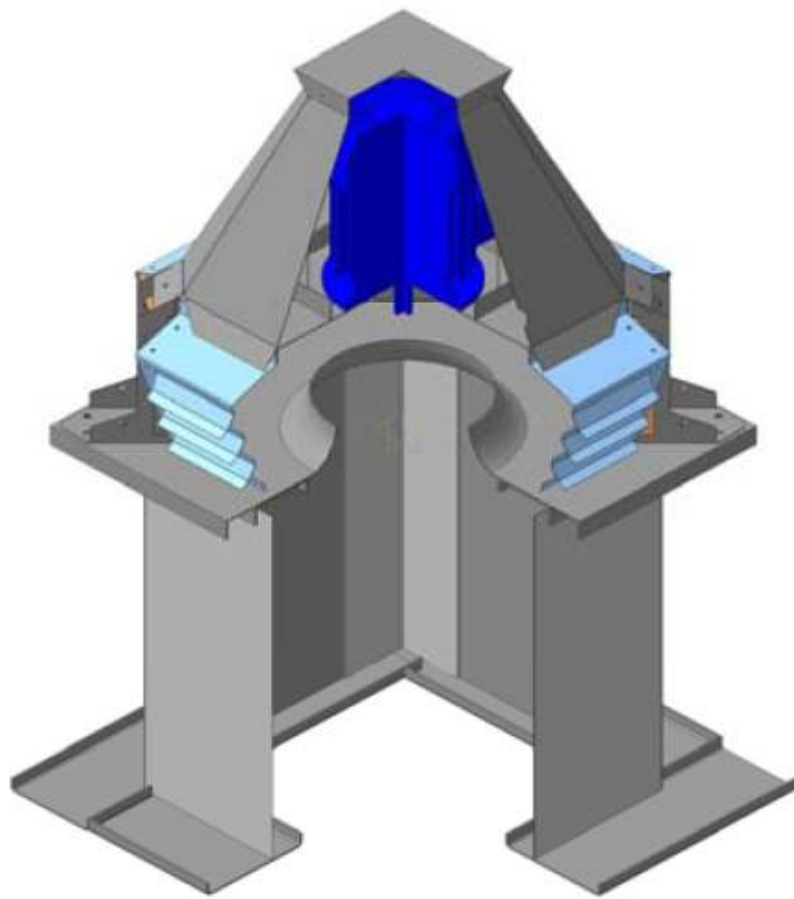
Монтаж крышного вентилятора КРОС-ДУ на стекле СТАМ производства ООО «ВЕЗА»
